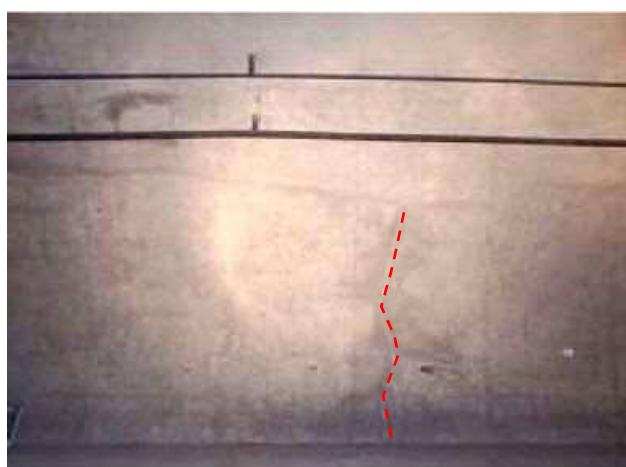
インバート拘束による横断方向のひび割れ
